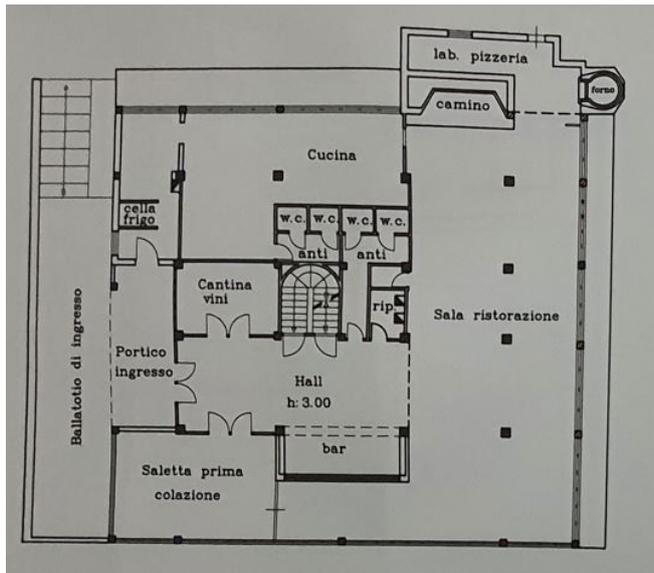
Stato autorizzato in Comune di Barbara – Piano terra
